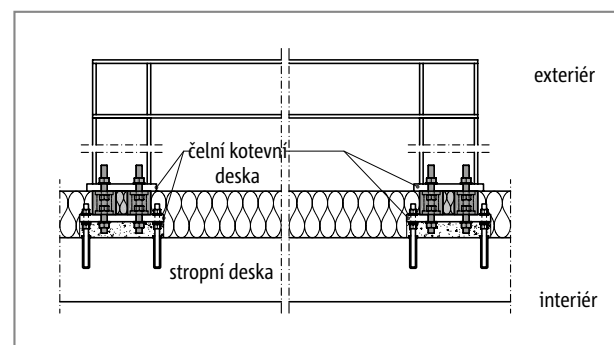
Schöck Isokorb® T typ S-N a T typ S-V: Dodatečně montovaná podepřená ocelová konstrukce; další příklady k tématu rekonstrukce viz strana 150
